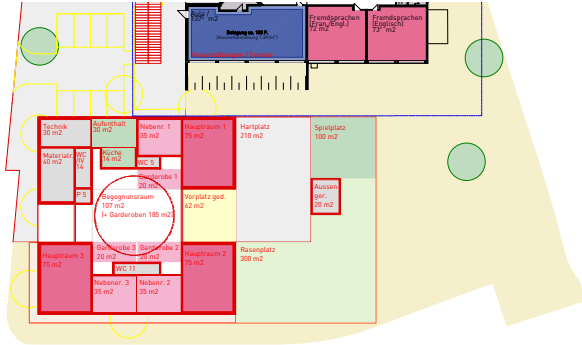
Schemaplan Kindergarten (Brugglismatt 3)
